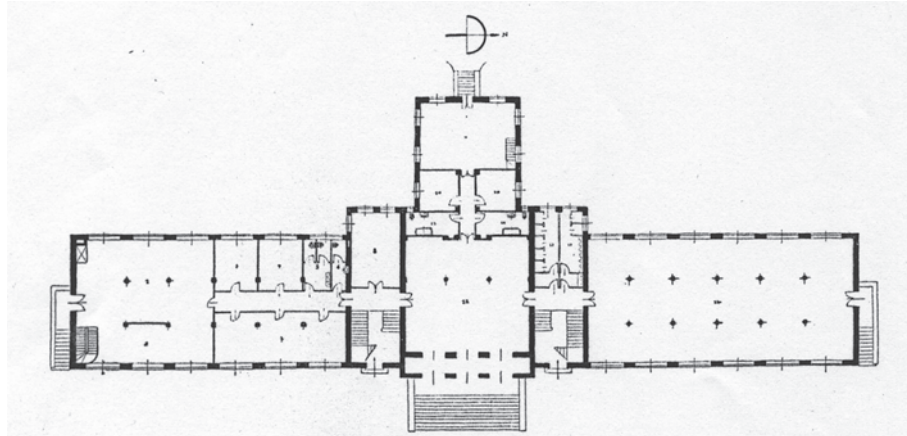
Ferienkolonie „Dalmine“: Grundriss EG
